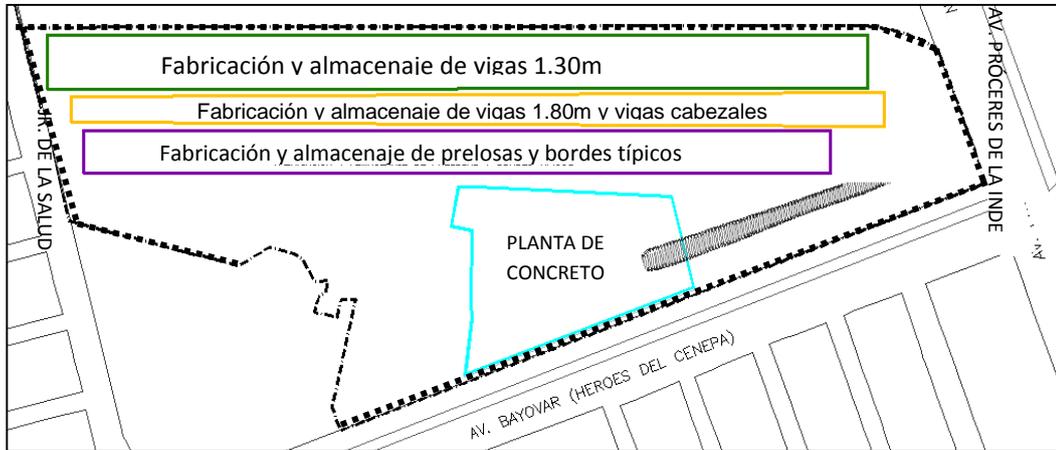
Distribución definitiva de áreas de trabajo en la planta de prefabricados del tramo 2 de la construcción del viaducto del tren eléctrico
